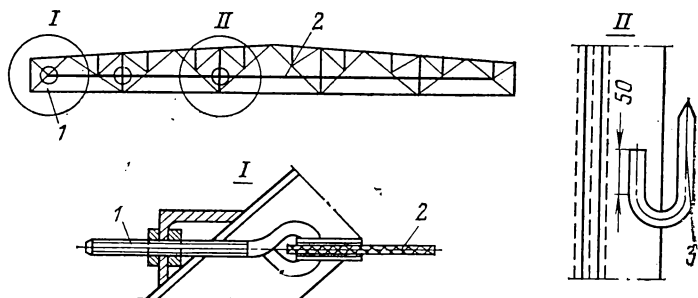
Предохранительный канат для прохода вдоль фермы.
